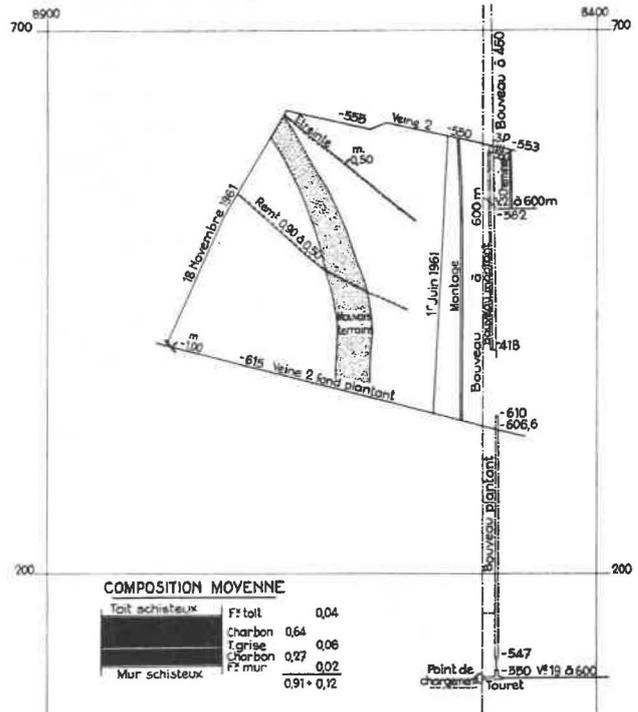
Chantier : Veine 2 couchant à 600 m. Fond plantant.
